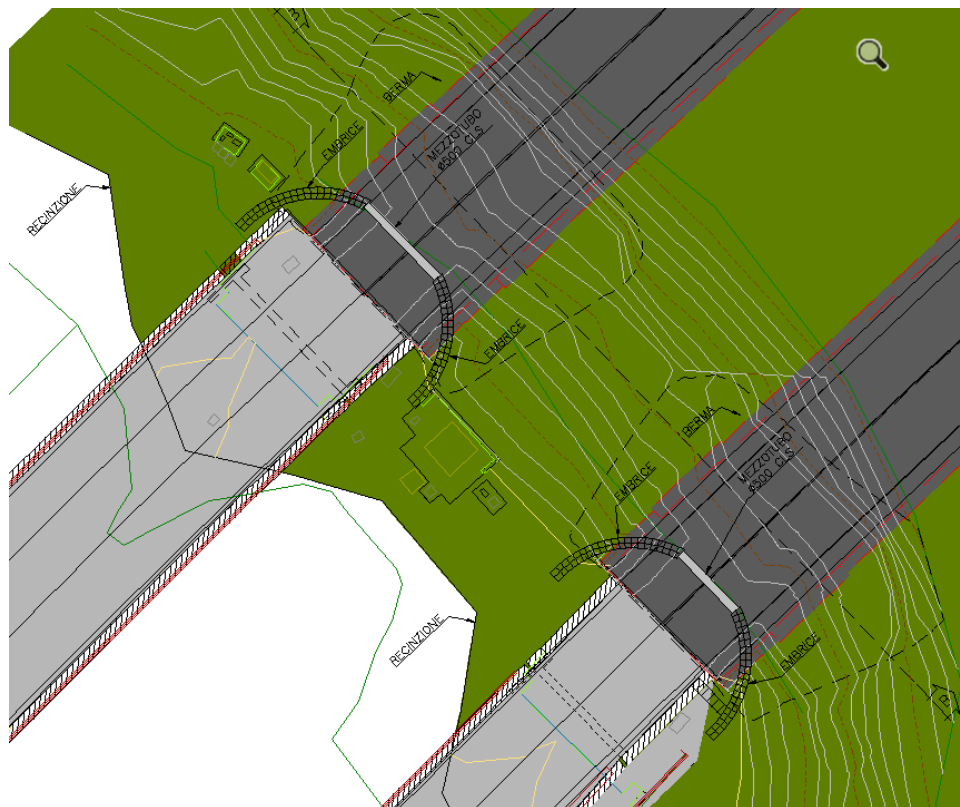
Planimetria degli imbocchi lato RM con ricostruzione delle curve di livello nella sistemazione finale del ricoprimento.
